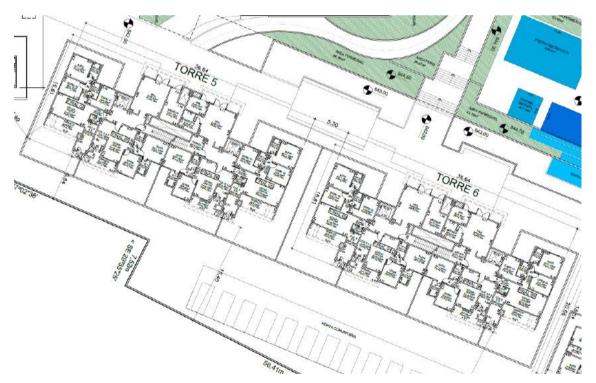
Projeto - Pavimento Térreo - Torres 5 e 6.
